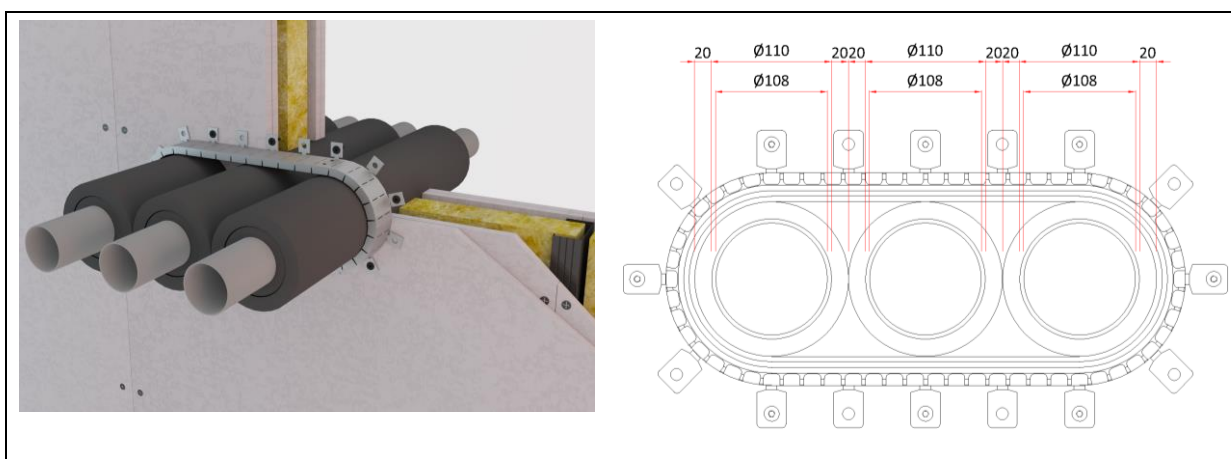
Ejemplo de sellado de penetración de un conjunto de tuberías metálicas aisladas en una pared flexible.
